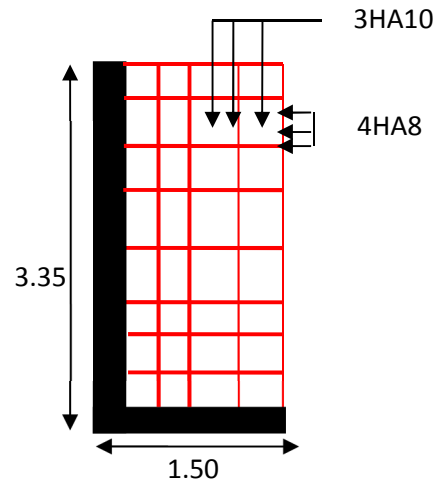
Schéma ferrailage de dalle sur 2 appuis (plancher)
